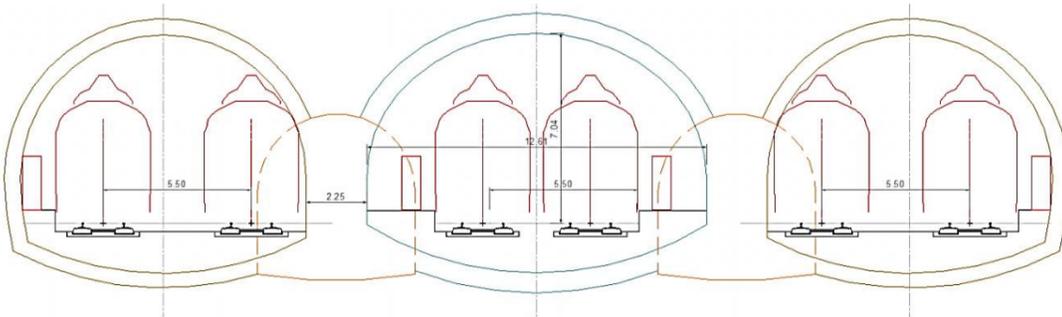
Coupe transversale au droit des voies de communications croisées (type 5 + 2 types 4)
